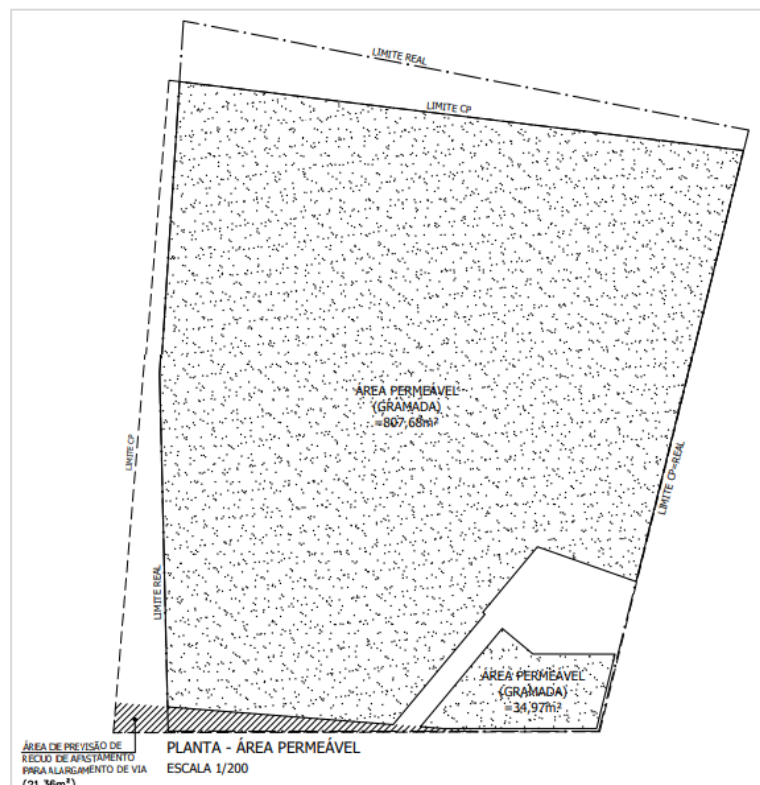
Planta de situação área de previsão de recuo de afastamento - Fonte: Requerente/2023
